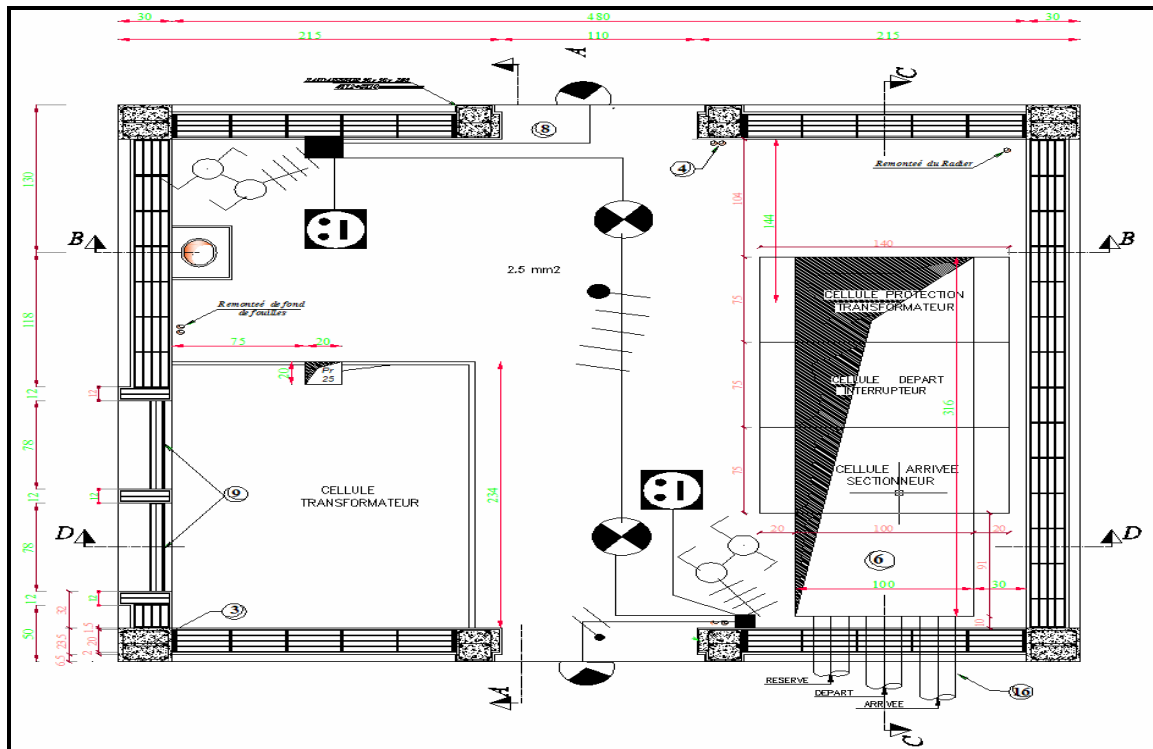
plan d'éclairage d'un poste livraison à comptage BT
